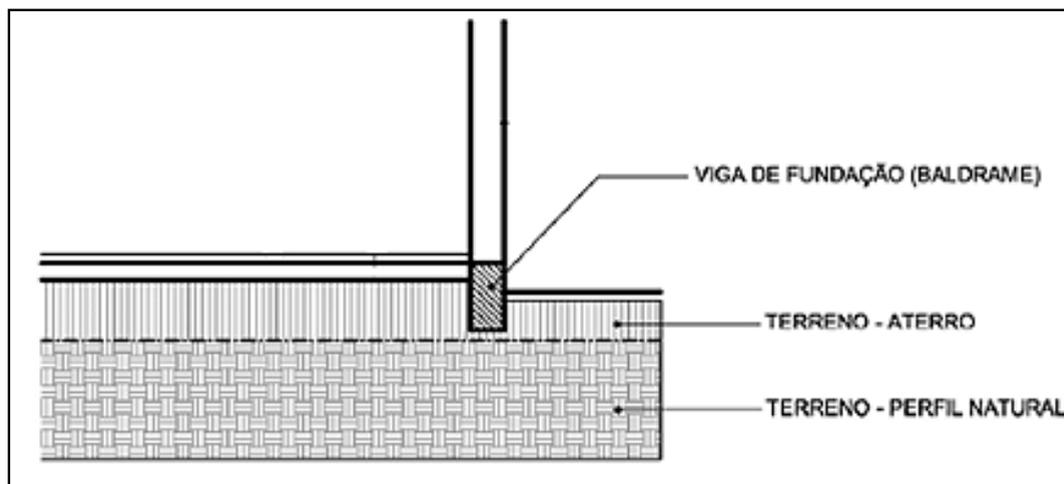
REPRESENTAÇÃO DE PAREDES, LAJES E VIGAS
